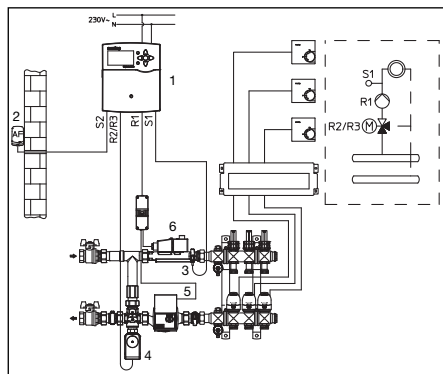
Vue d'ensemble du raccordement des composants (un circuit de chauffage mélangé)
